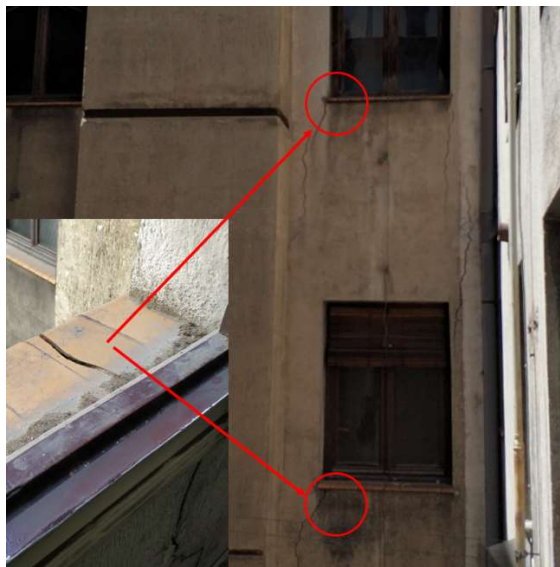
Fisuras verticales en bordes de machones entre ventanas del núcleo, por asentamiento
